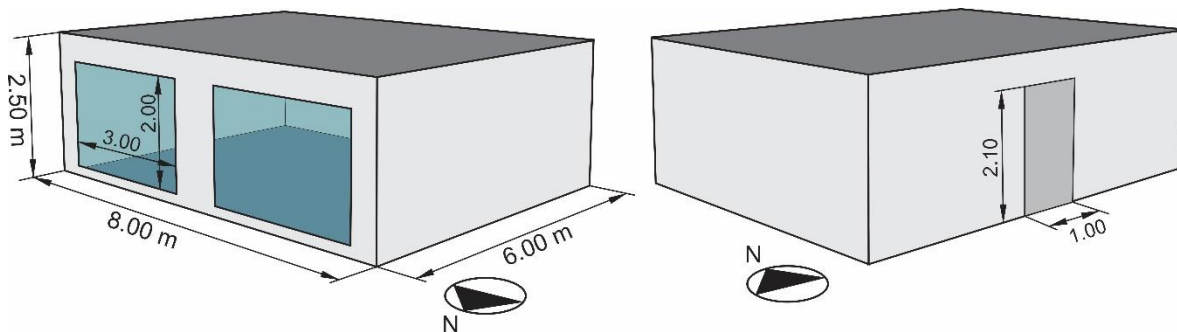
Planta ilustrativo del modelo Bestest 900.
